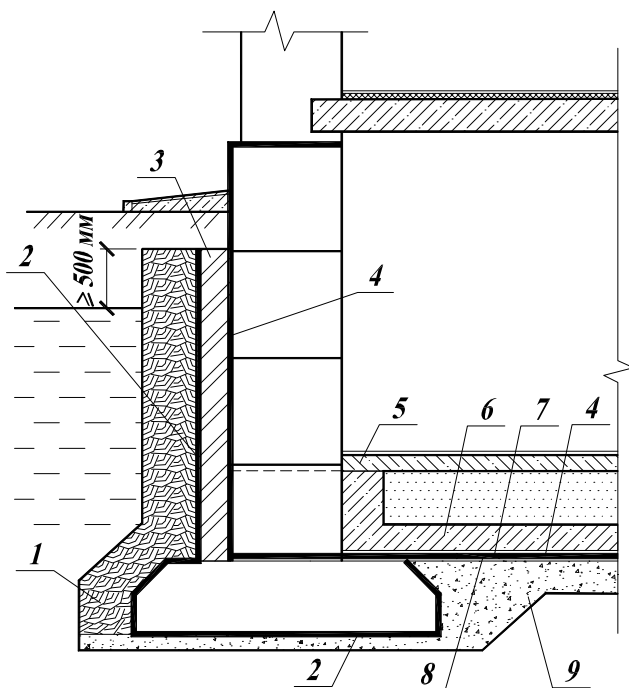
Изоляция фундаментов от агрессивных подземных вод:
